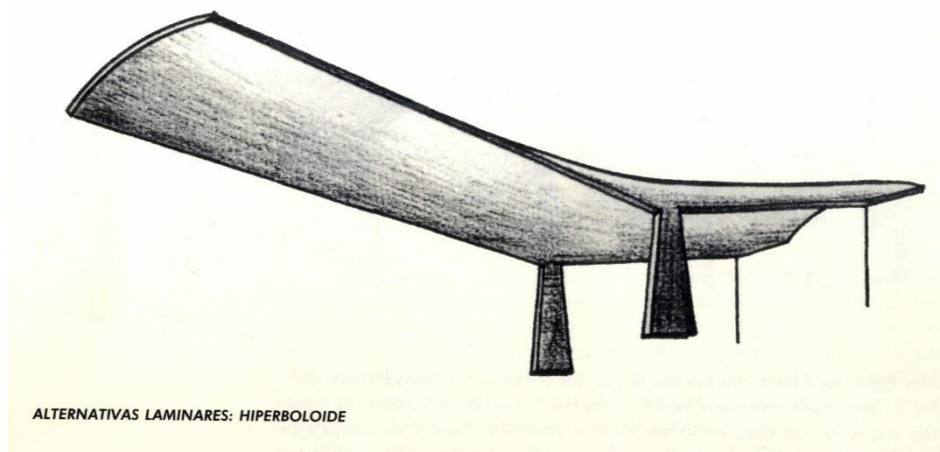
Croquis de la estructura laminar utilizada finalmente en la cubierta de las tribunas. (Fuente: Libro “Las Estructuras de Eduardo Torroja”, 1999)
